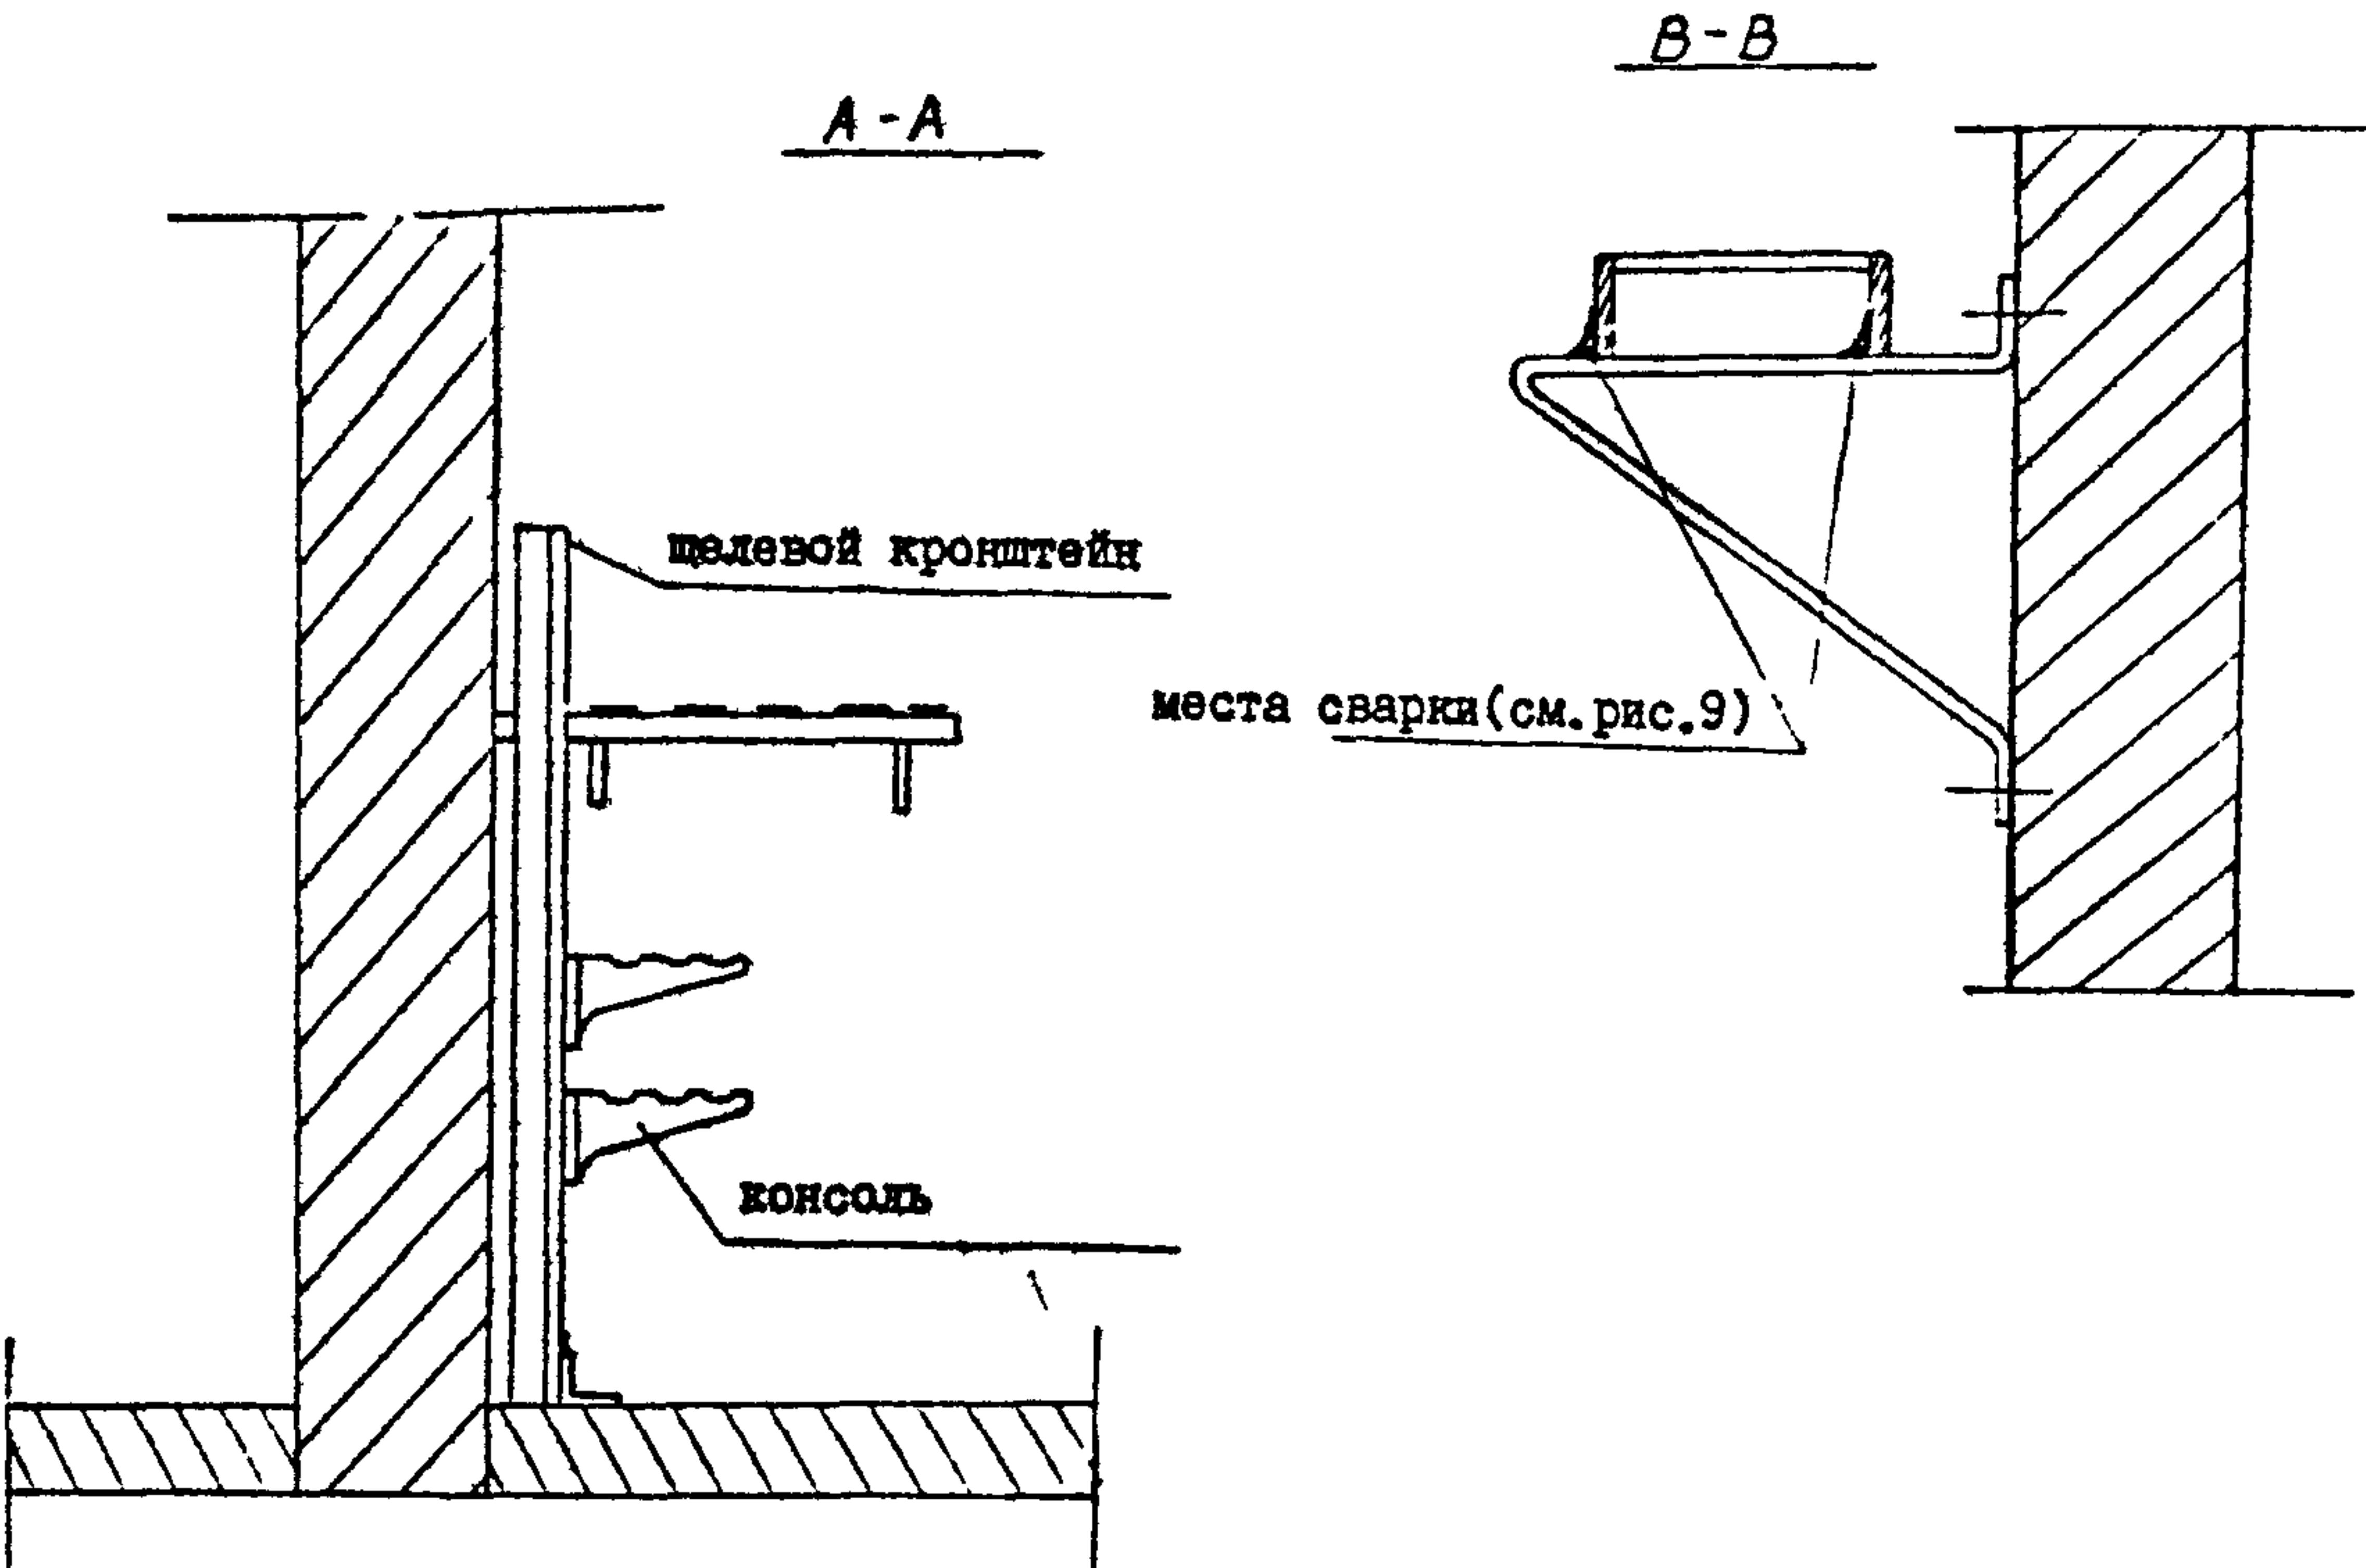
Расположение и места сварки желобов в шахте (примерное)
